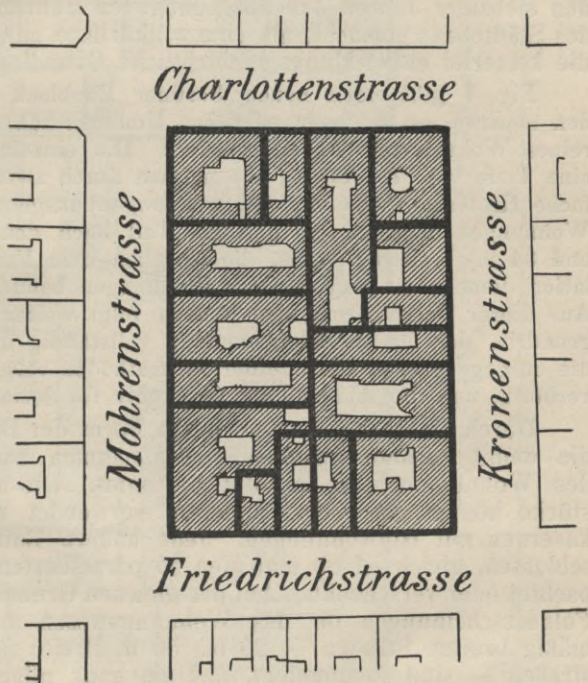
Alter Berliner Baublock der Friedrichsstadt (Geschäftsviertel) in der Bebauung von 1902. Maßstab 1:2000.
